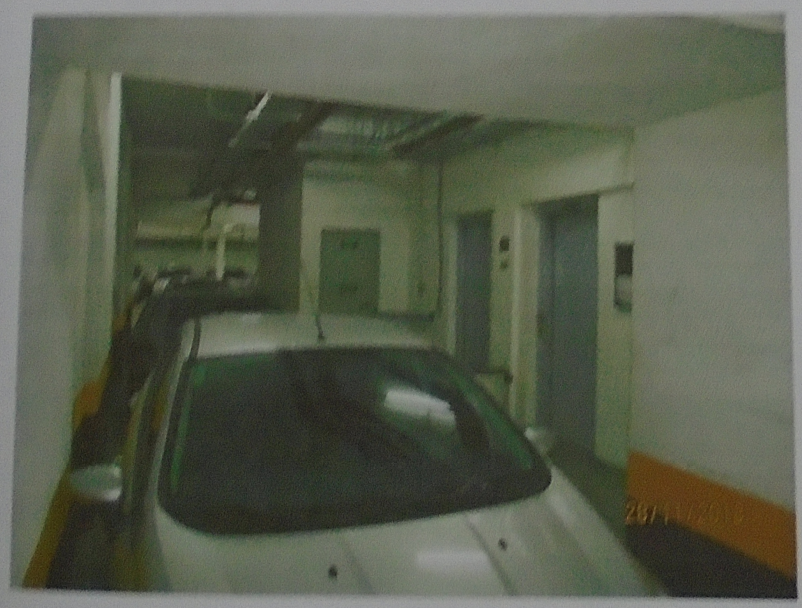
Vista do hall de elevadores no subsolo, possui estacionamento com manobrista.
